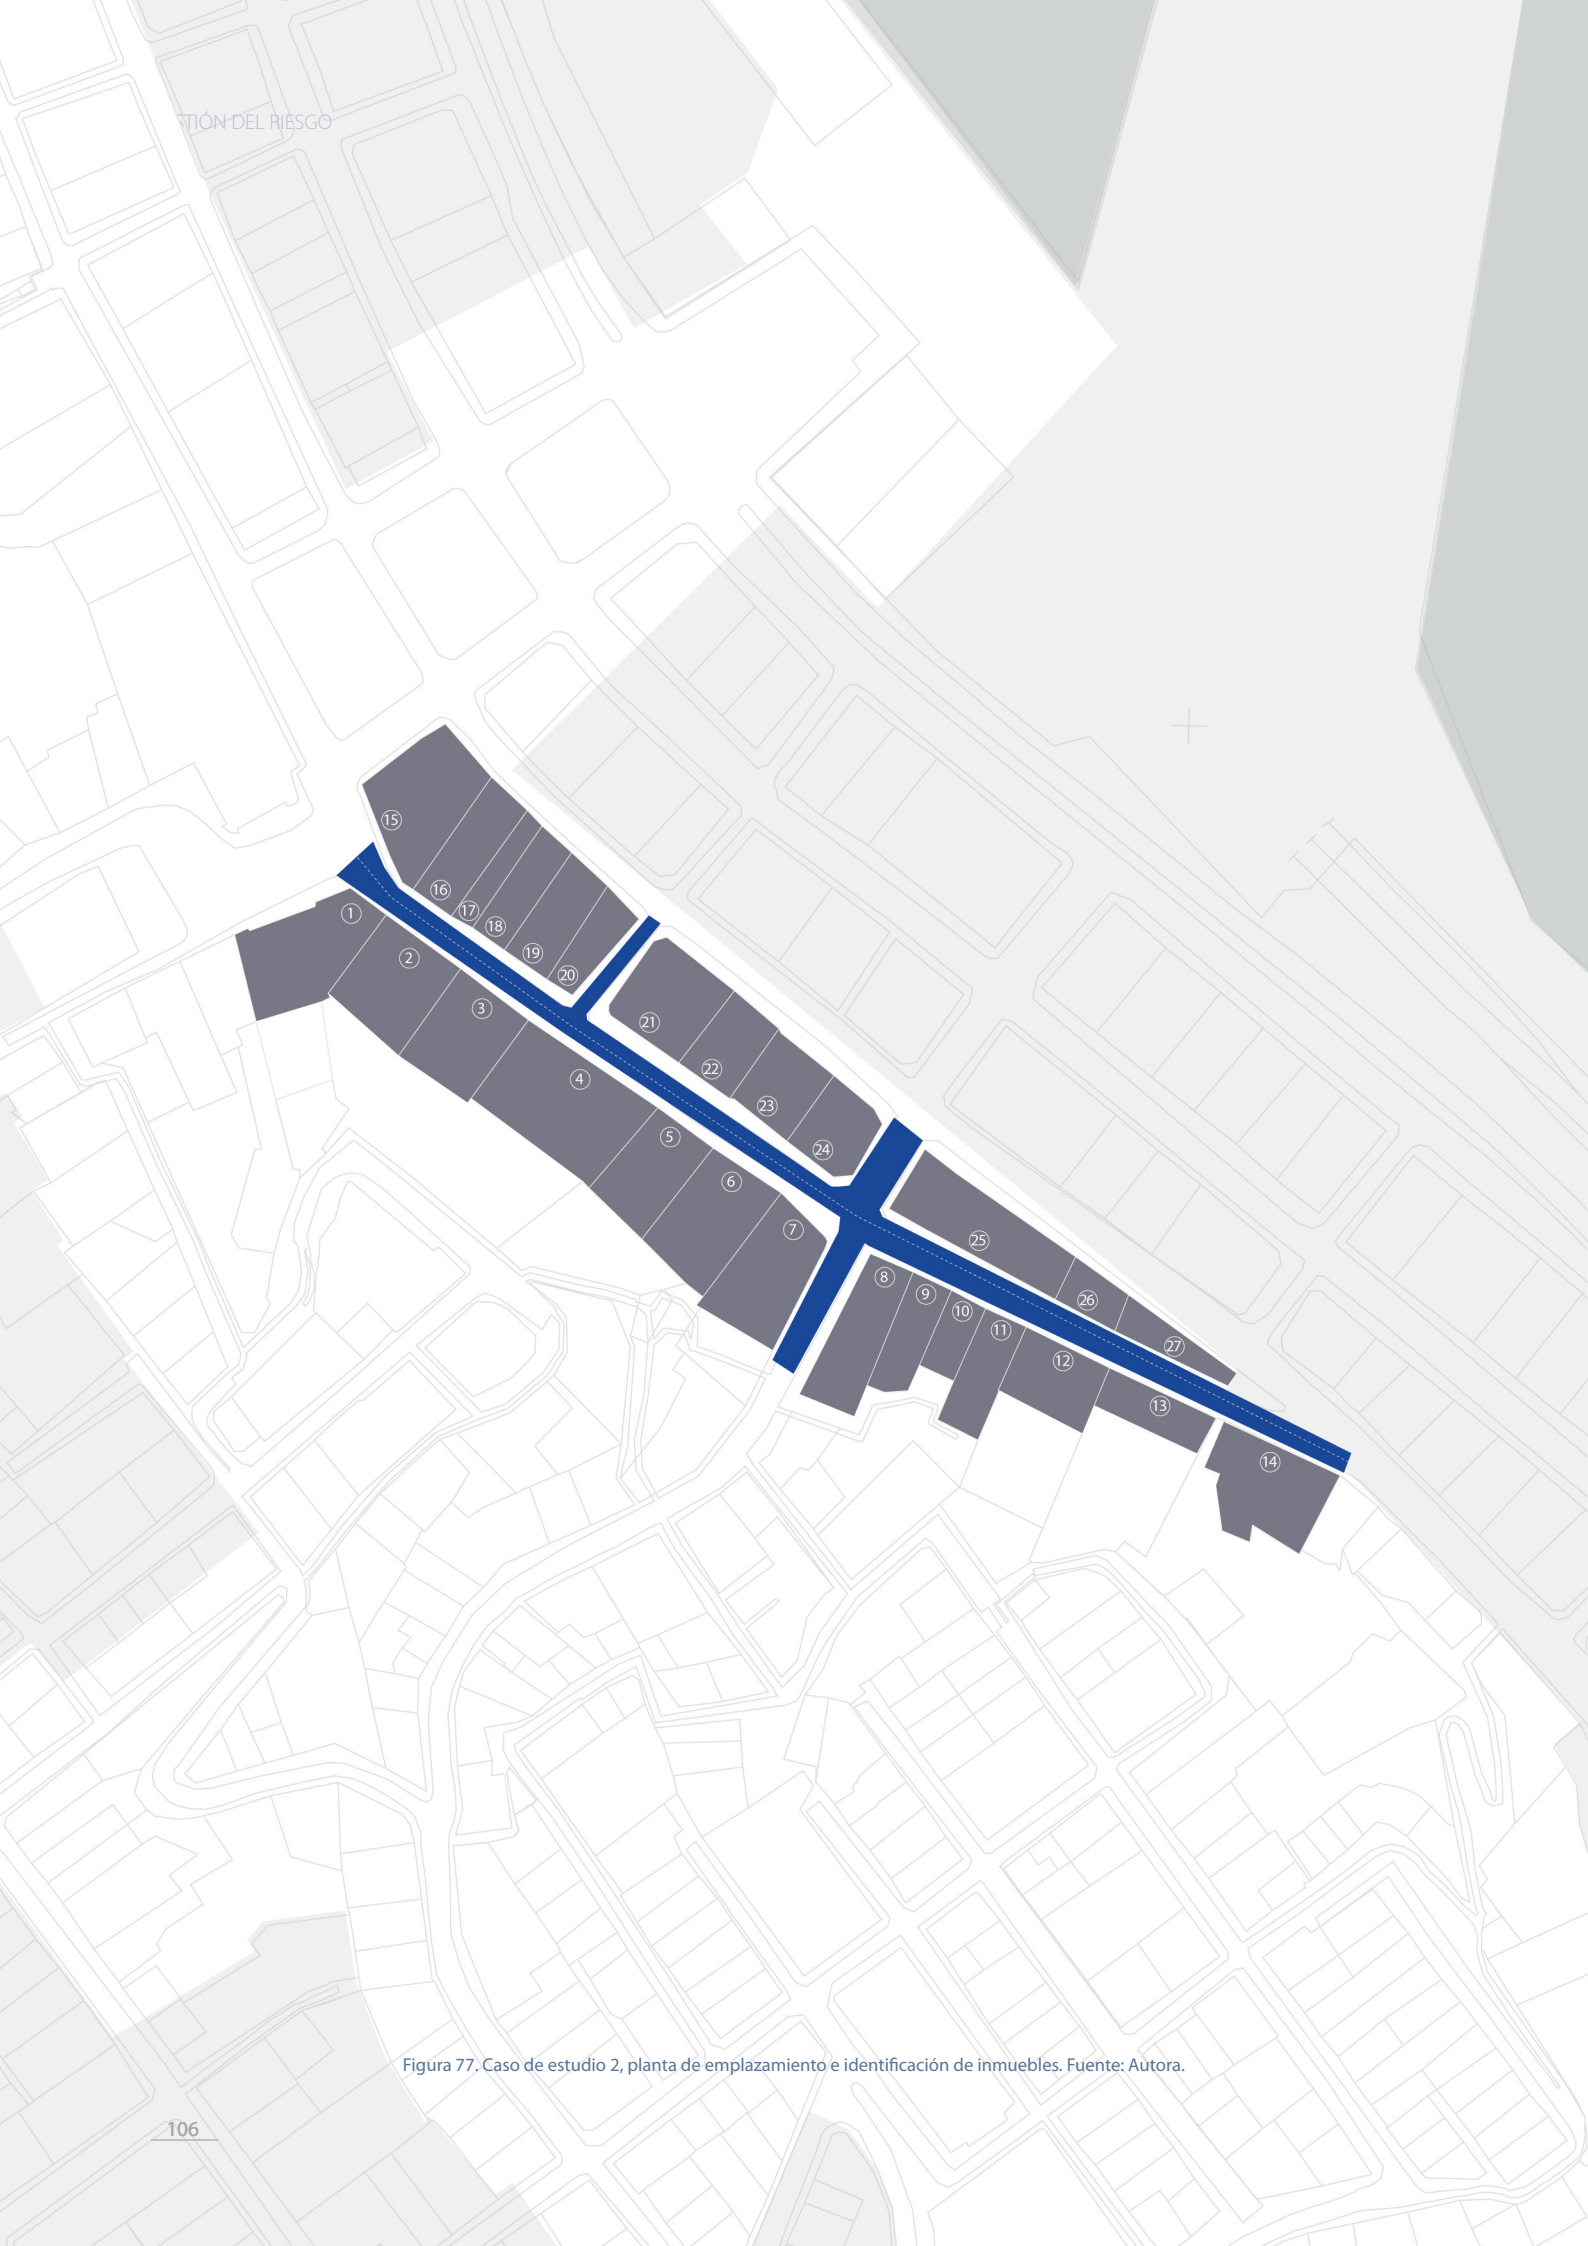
Caso de estudio 2, planta de emplazamiento e identificación de inmuebles. Fuente: Autora.
